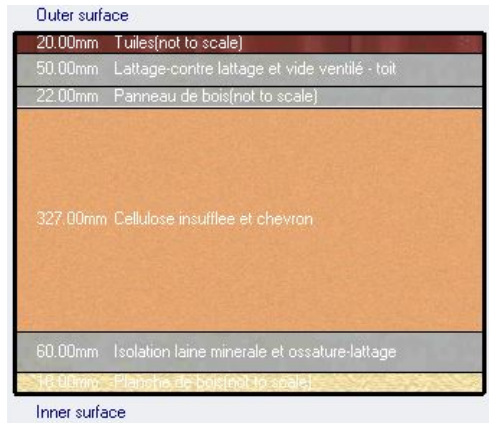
DesignBuilder - Construction - Toiture - Illustration
